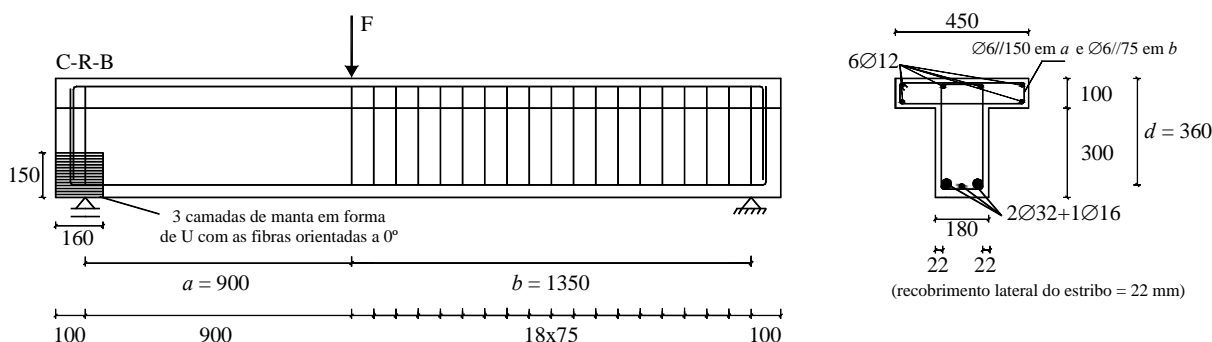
Geometria das vigas da série B (dimensões em mm).
